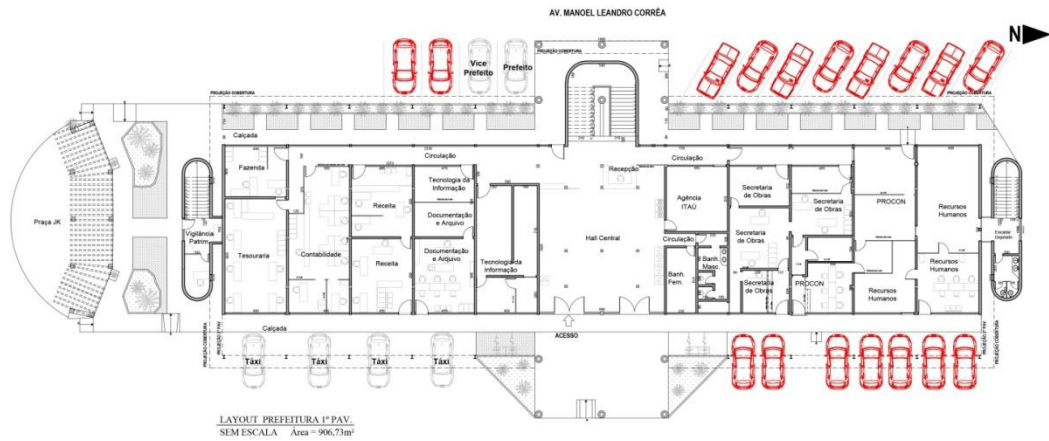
Planta Baixa do 1º Pavimento da Prefeitura com a disposição do estacionamento.
